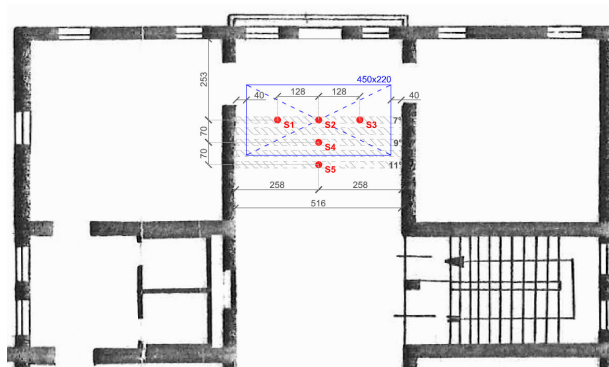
prova n°4 (Edificio Villa Torni, solaio 1° piano).
